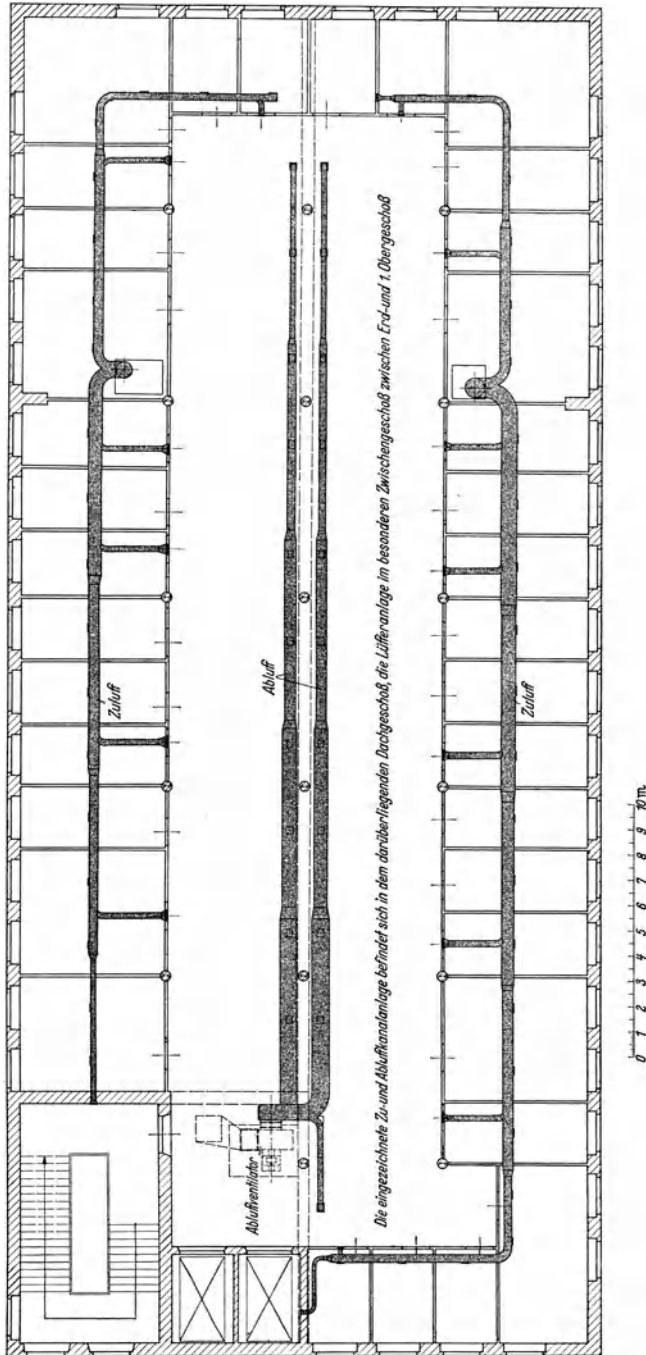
Ausgeführte Entbebelungsanlage für die große Kuttel einer Schlachthofanlage. Grundriß: 1. Obergeschoß — Darmschleimerei.
